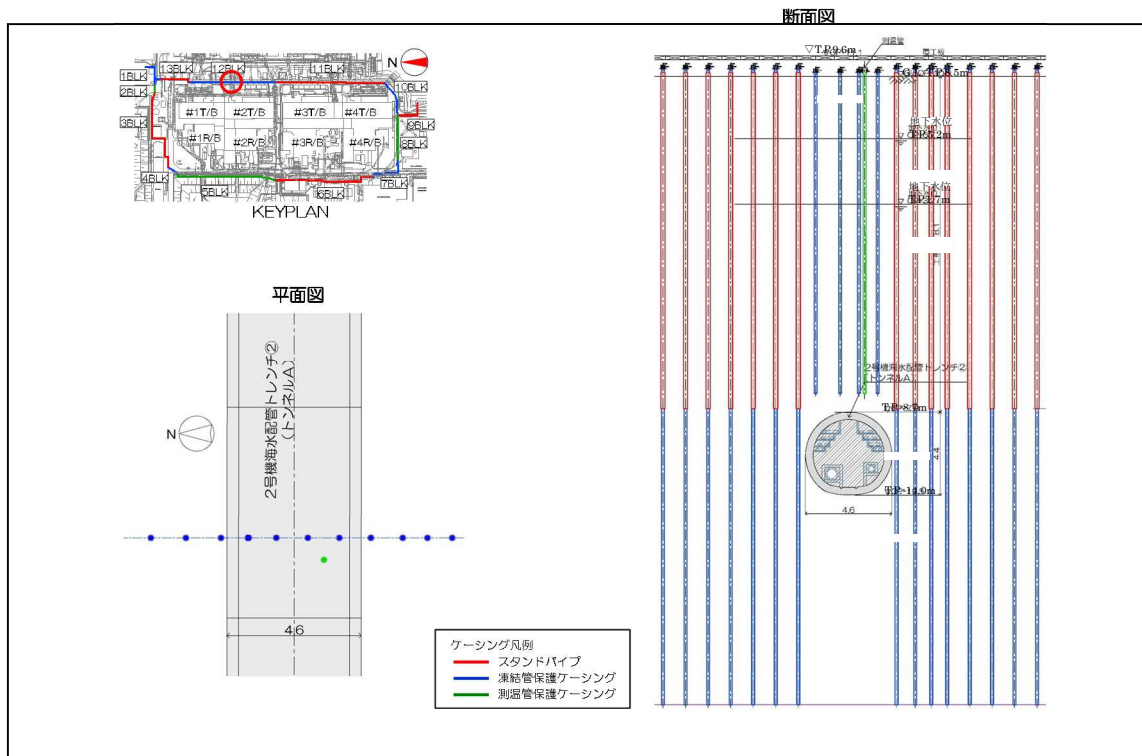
2号機海水配管トレンチトンネルA部 施工平面図・断面図
